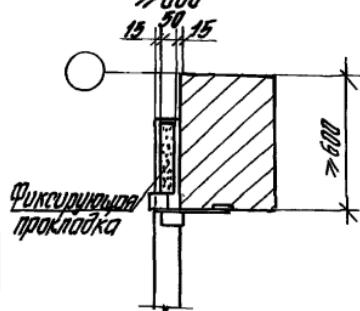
В поперечных перегородках у крайних колонн здания с высотой сечения колонны ≤ 500
